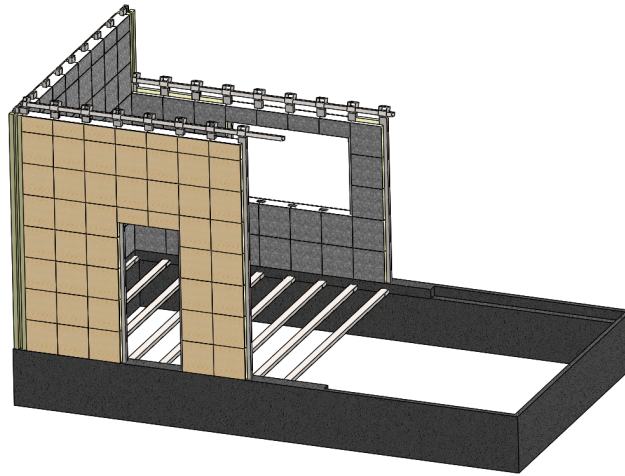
Montagem dos encaixes parede-teto e das vigas longitudinais.
